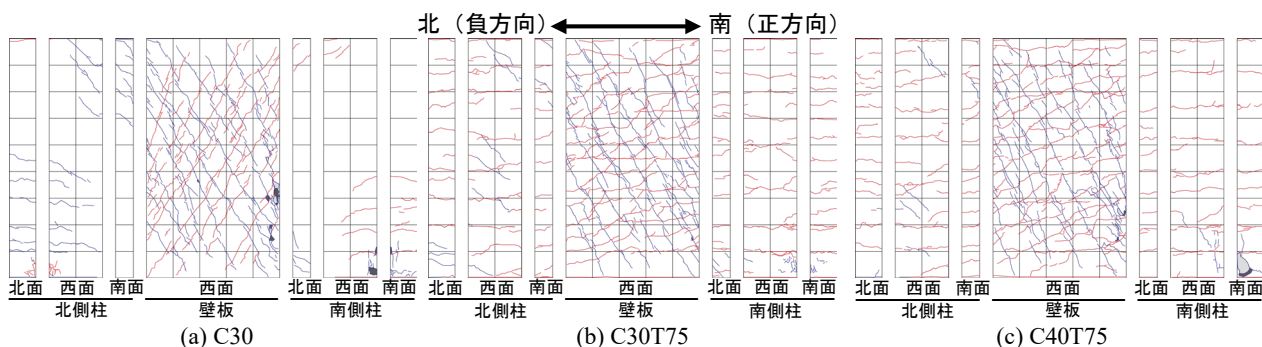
$R=0.75\%$ 時ひび割れ図
